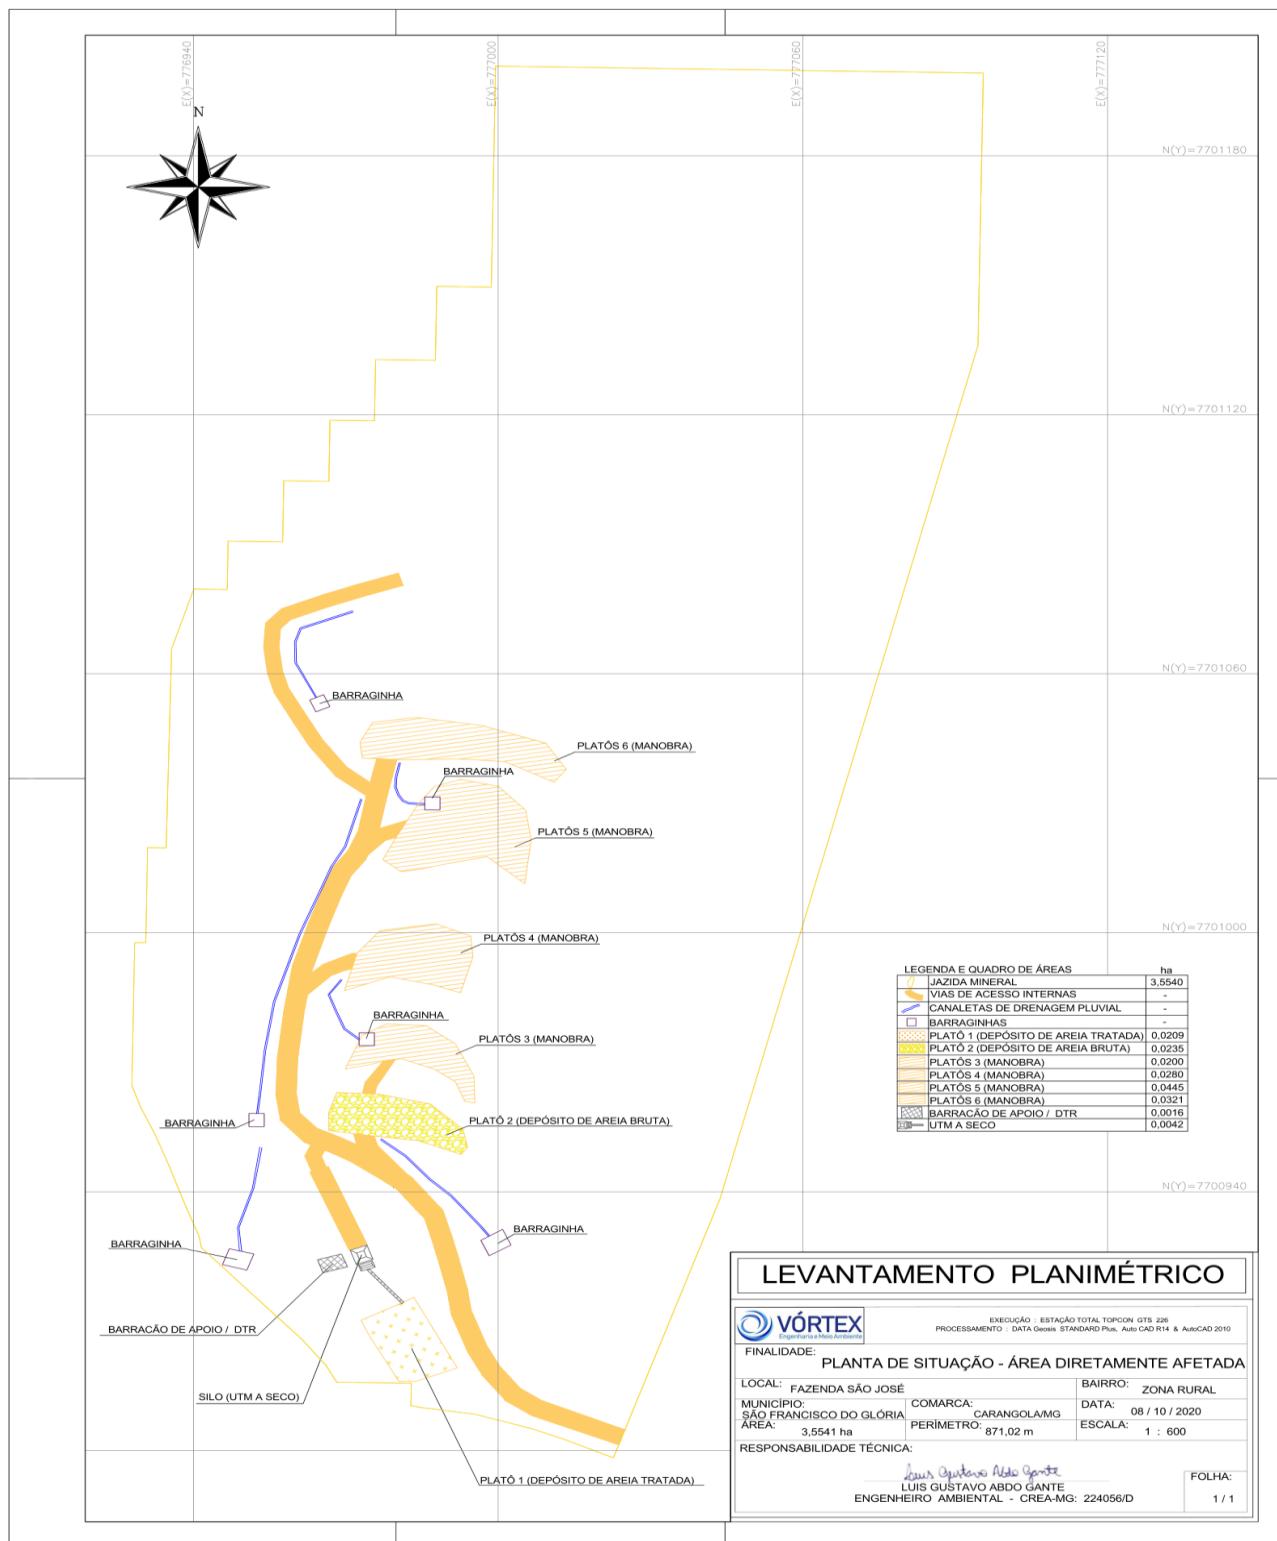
imagem mais detalhada da planta planimétrica georreferenciada do empreendimento
